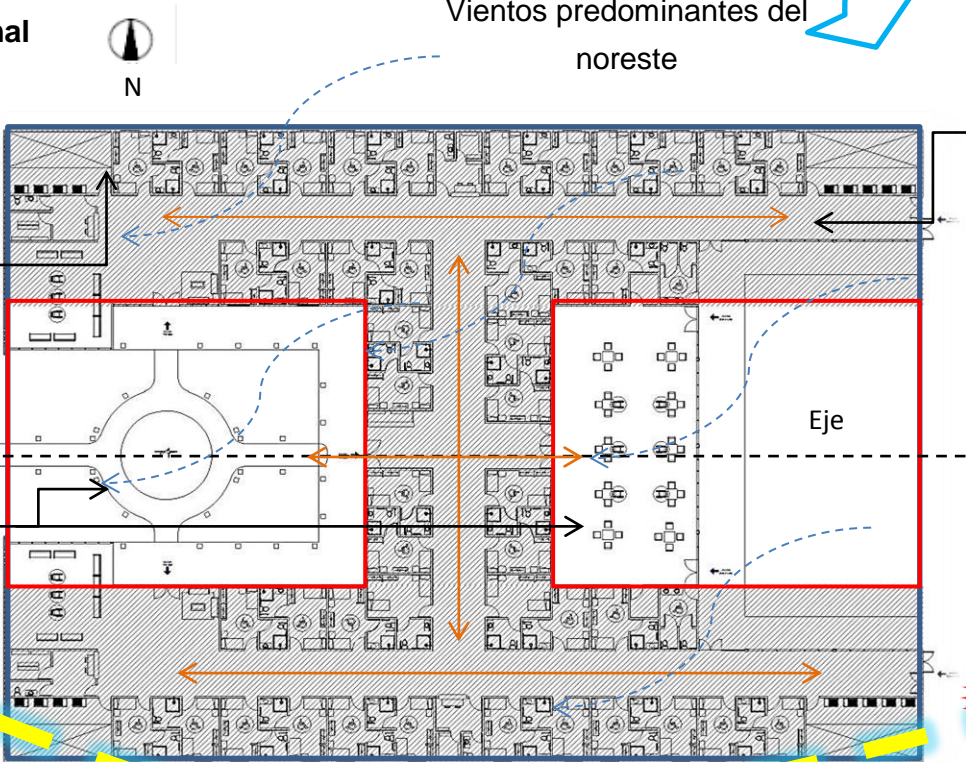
Planta arquitectónica dormitorios /Fuente: Propia
